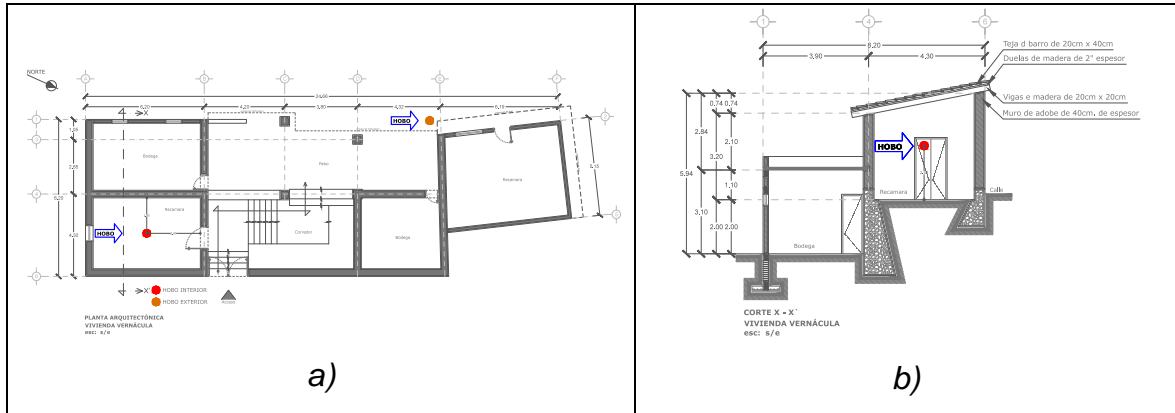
Vivienda vernácula: a) Planta arquitectónica y b) Corte arquitectónico
